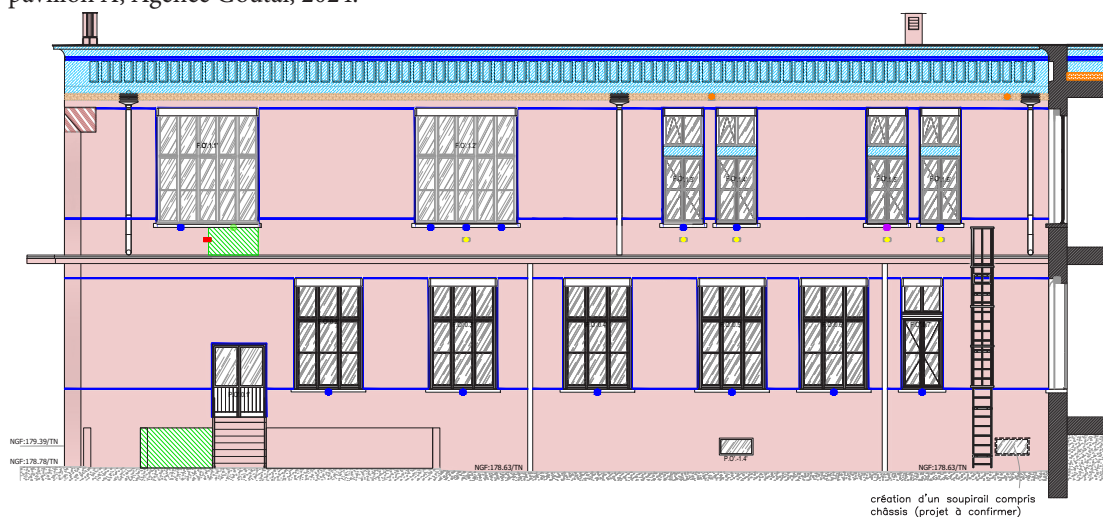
État projeté (APD) du lot Gros-oeuvre - maçonnerie - pierre de taille, coupe-élévation Ouest, pavillon A, Agence Goutal, 2024.
